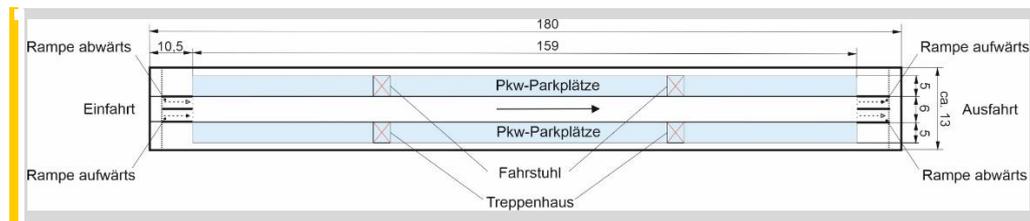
denkbare Parkhaus an der Rutnikstraße mit Halbrampen
